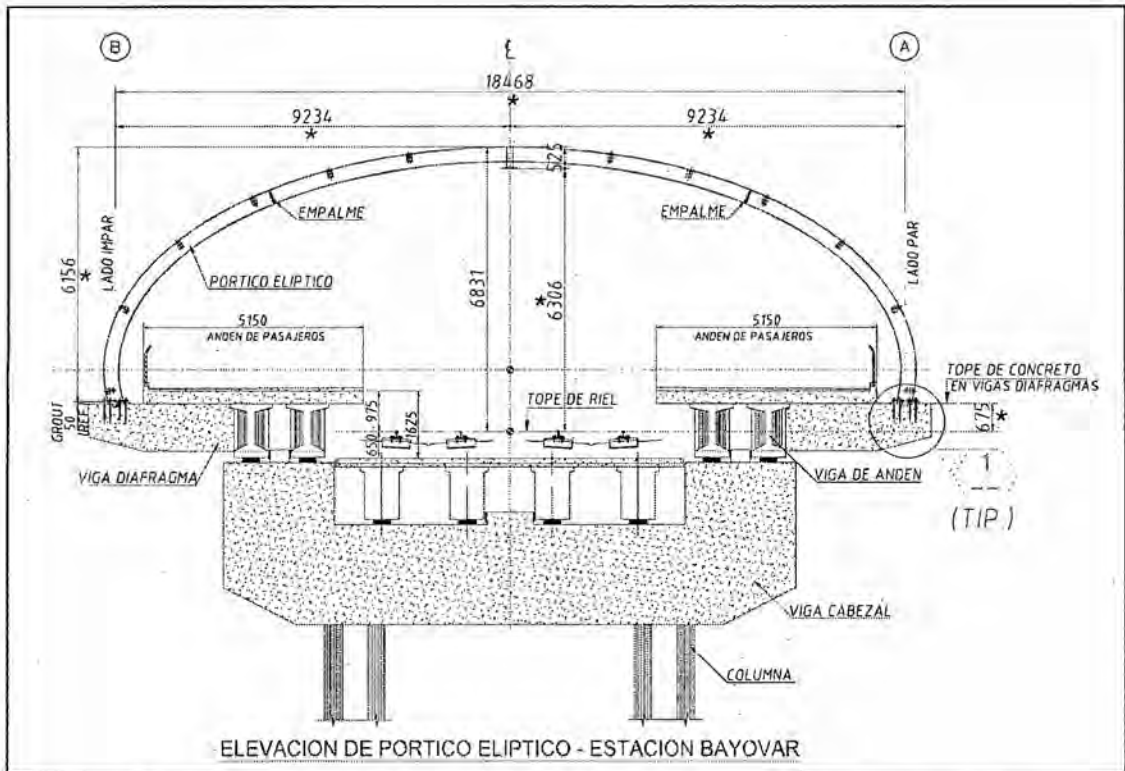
Geometría de Pórtico de Cubierta Metálica Andén (Fuente: Tramo 2)
